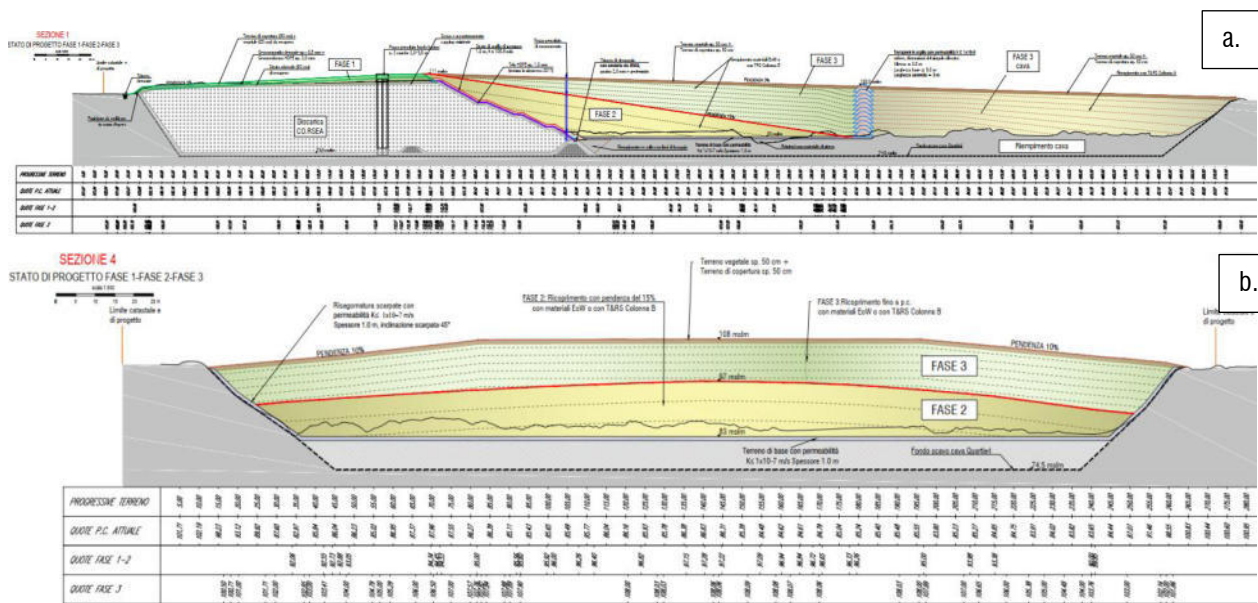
a. Estratto Sezione longitudinale n.1 con indicazione delle fasi di avanzamento; b. Estratto Sezione trasversale n.4 con indicazione delle fasi di avanzamento
